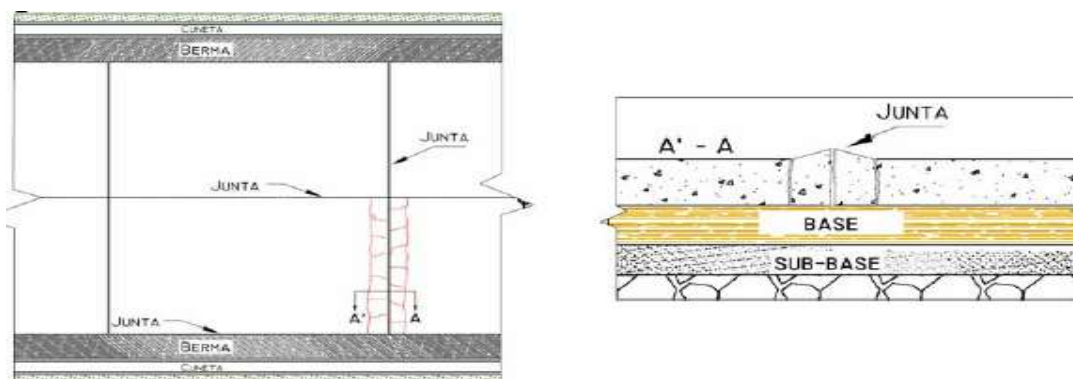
Vista de planta y perfil de levantamiento (LET -LEL) (INVIAS, 2006).
